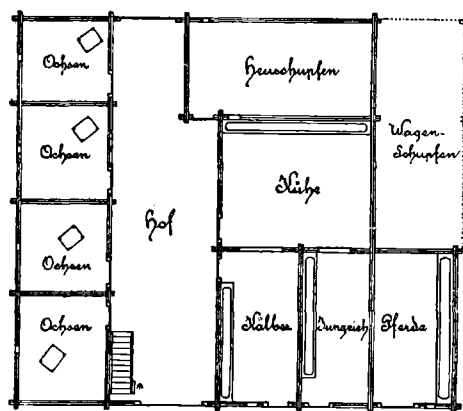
Grundriss des Erdgeschosses des Winkler-Stadels.
